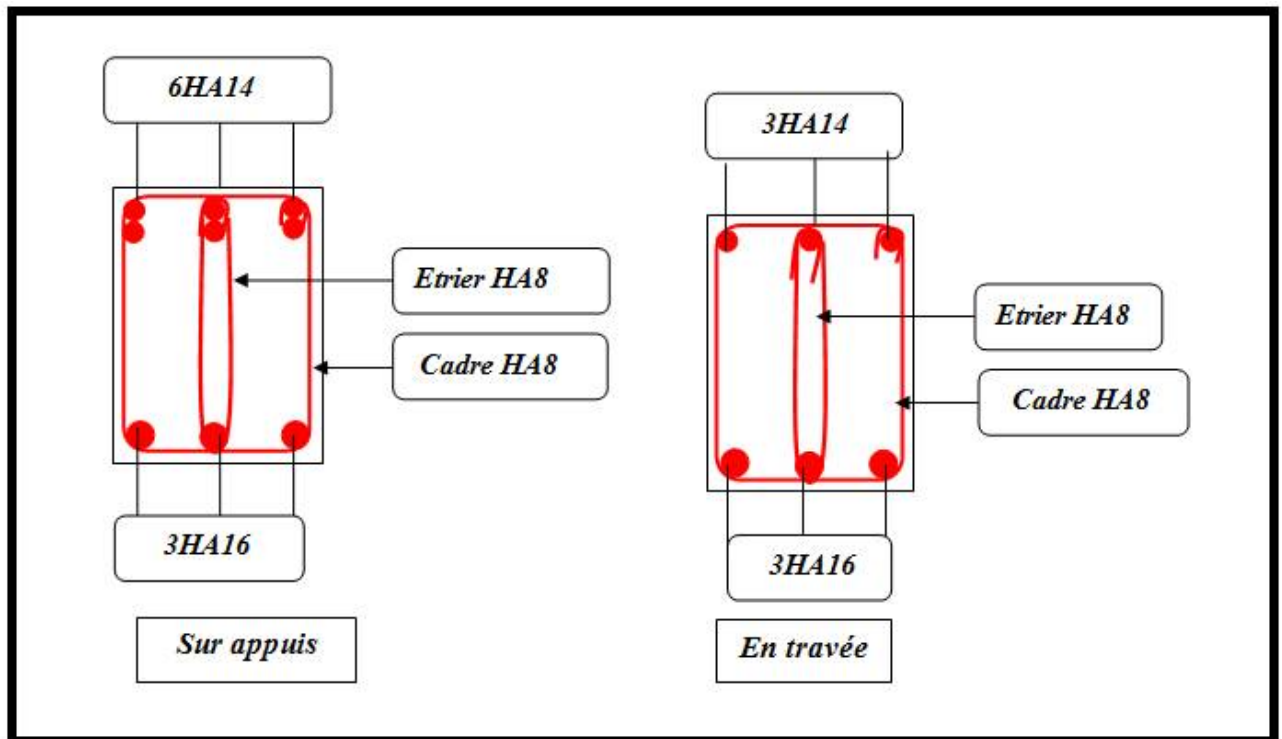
Schéma de ferrailage des poutres principales (30×40) cm.
